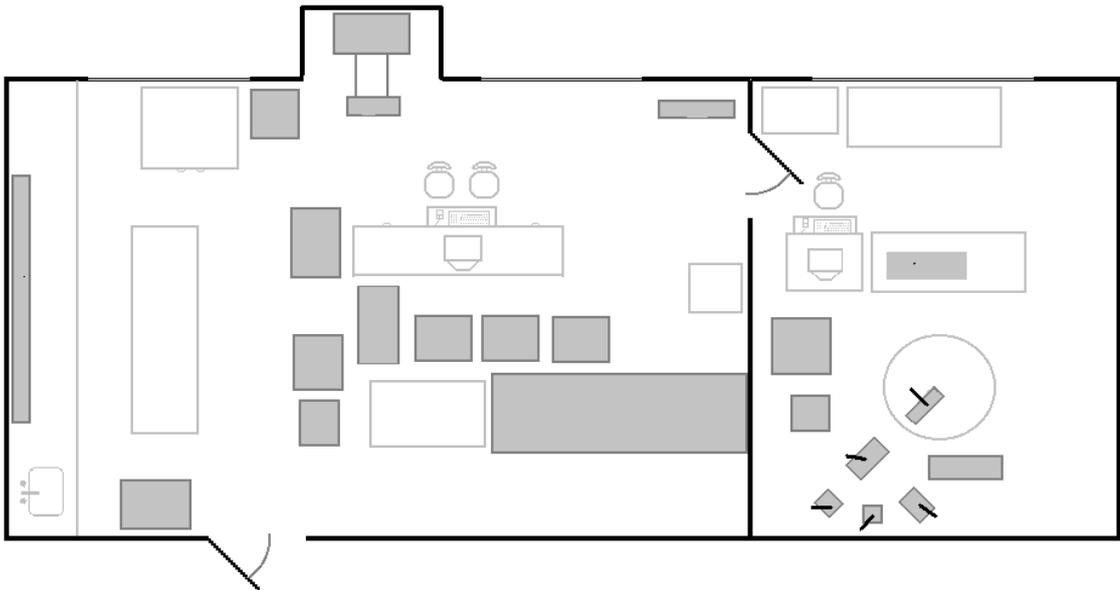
Distribución de laboratorio 03 (planta). Laboratorio de termómetros patrones.
